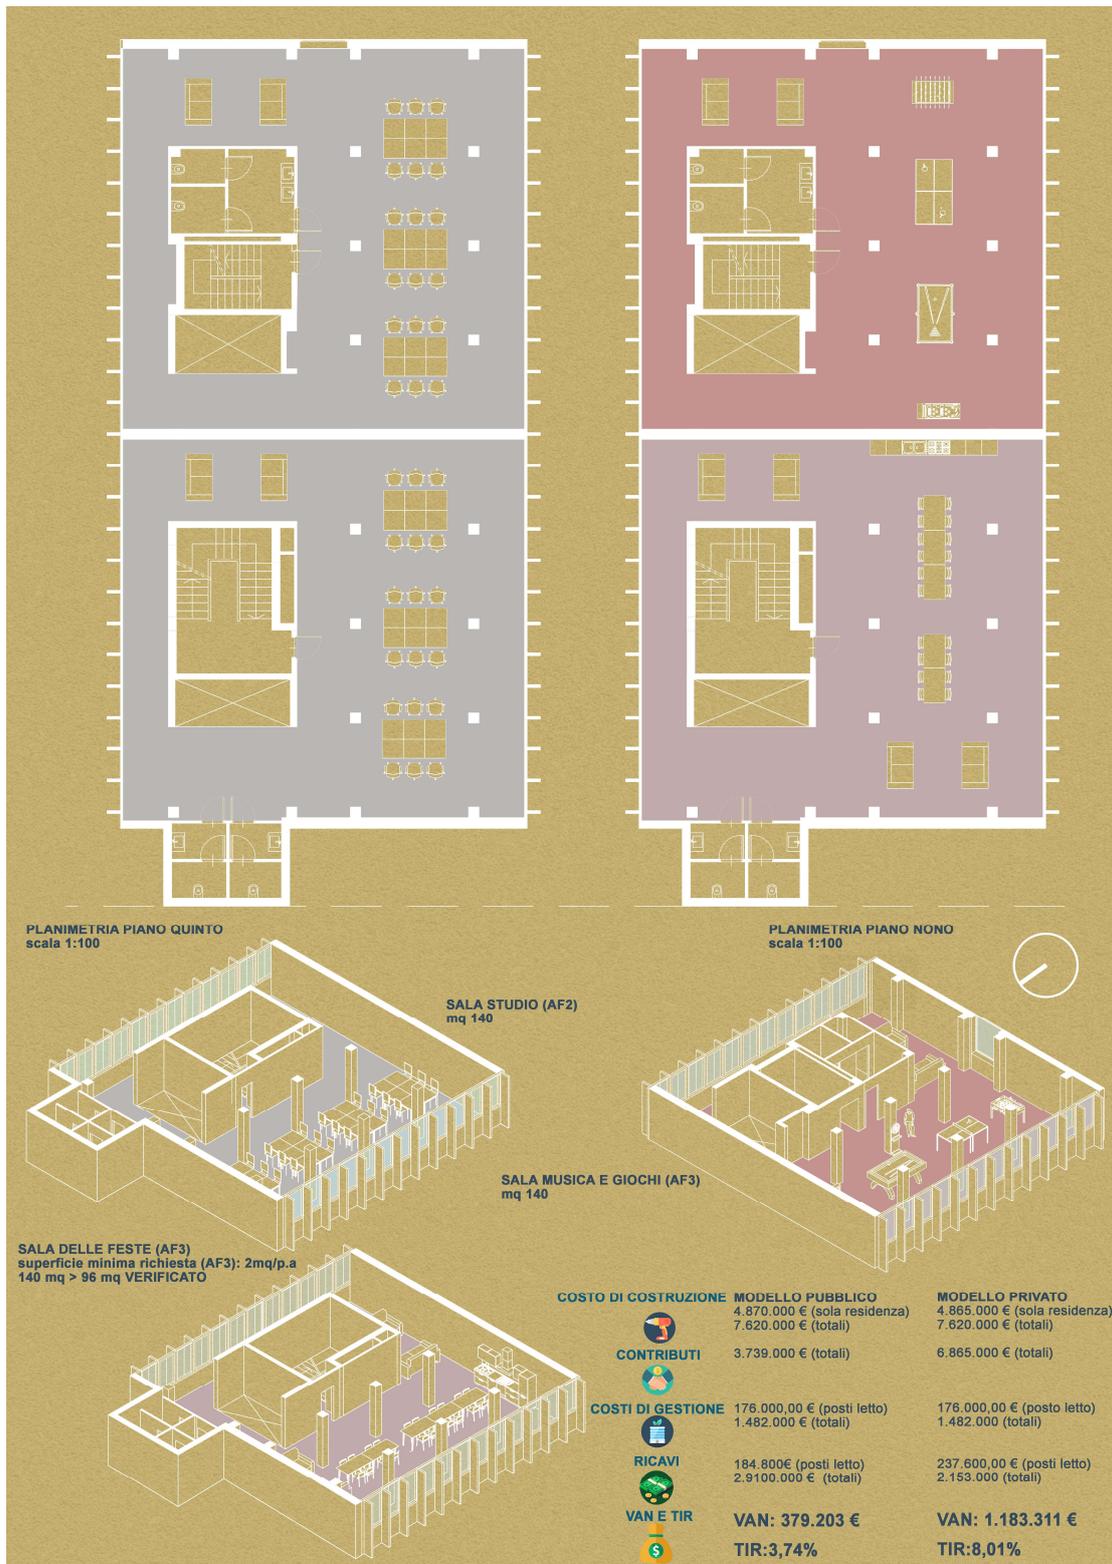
Tavola di progetto,planimetria e spaccato assometrico del 5° e 9° piano.
